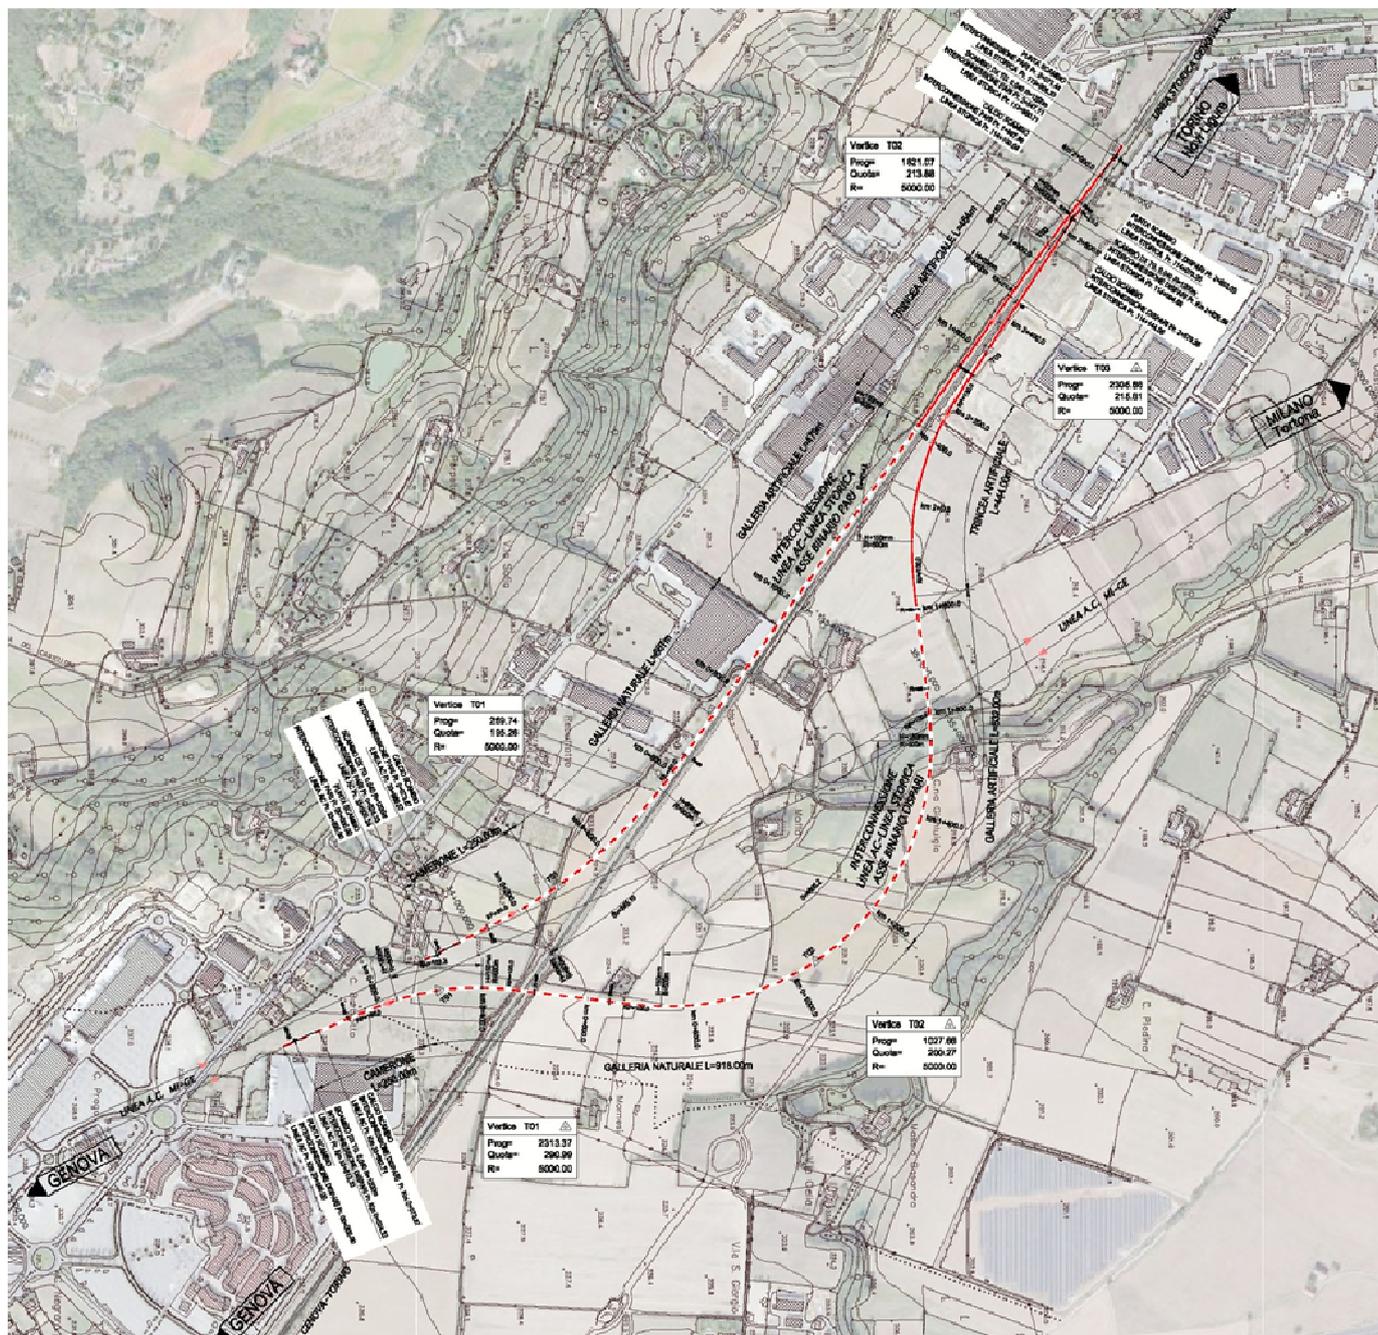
Stralcio planimetrico interconnessione 100 km/h
